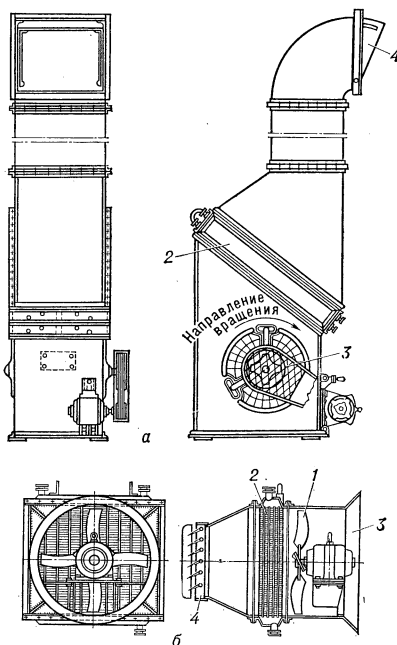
Агрегаты воздушного отопления: а — устанавливаемые на полу; б — укрепляемые на строительных конструкциях (колоннах, стенах и т. п.); 1 — вентилятор; 2 — воздухоподогреватель (калорифер); 3 — всасывающее отверстие; 4 — нагнетательное отверстие.
